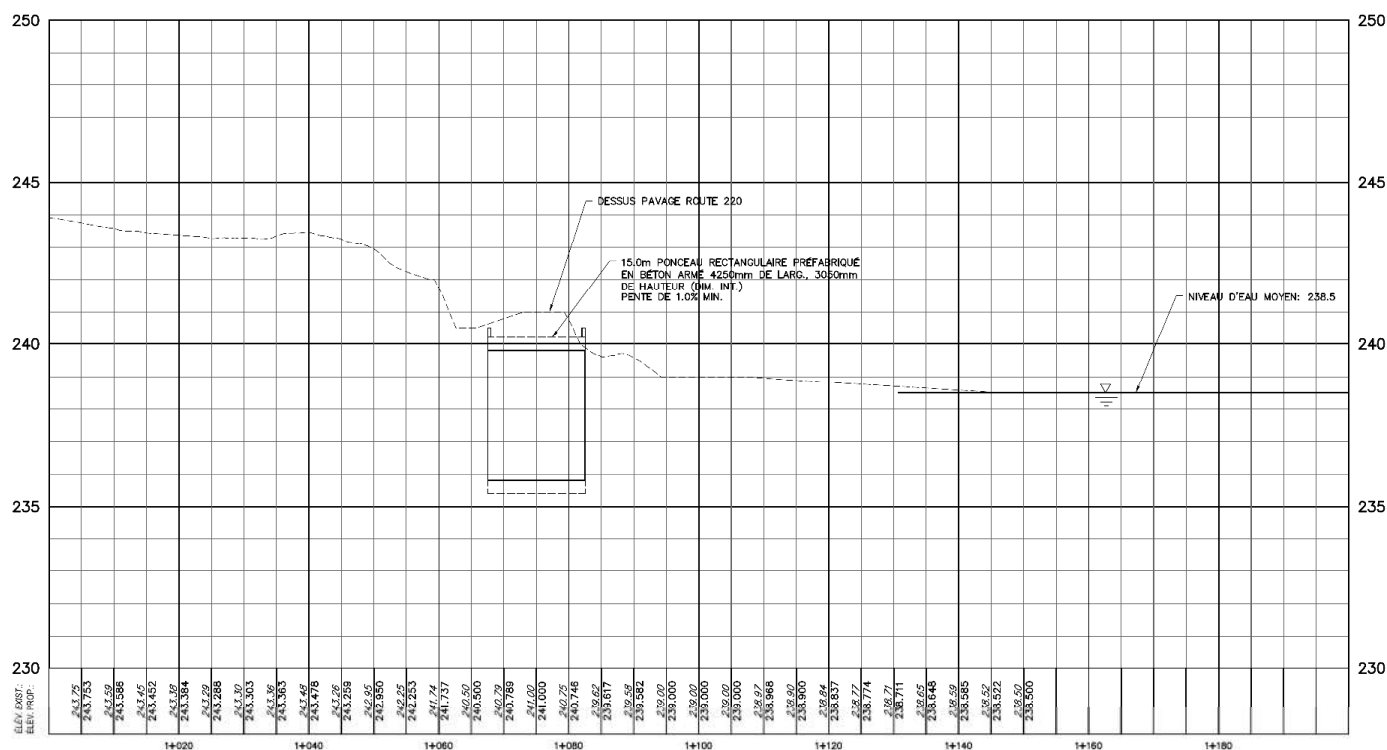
Profil en travers au droit de la traverse projetée sur la route 220 (Lac Brompton)
